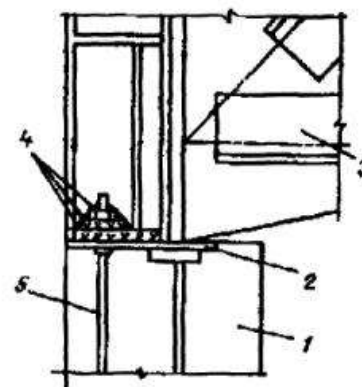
Пример крепления стальной фермы к железобетонной колонне:
